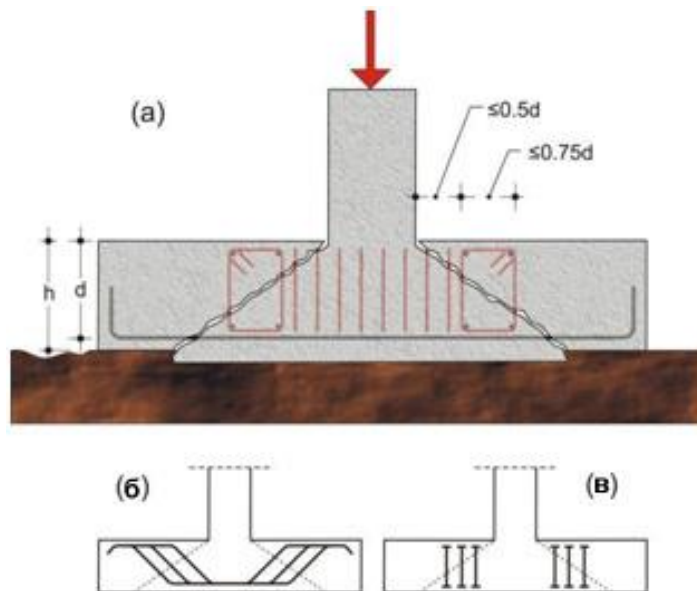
Гнучкий фундамент мілкого закладення та способи його армування: а – зони руйнування фундаменту, б, в – армування у зоні руйнування.
